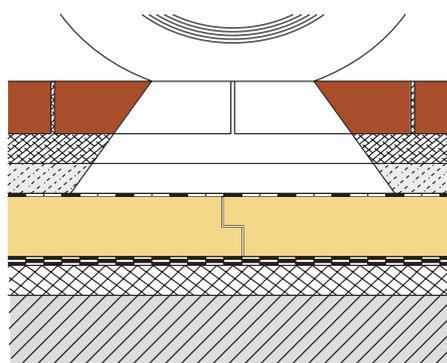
Tetto rovescio carrabile con autobloccanti (distribuzione del carico con angolo di 60°)
